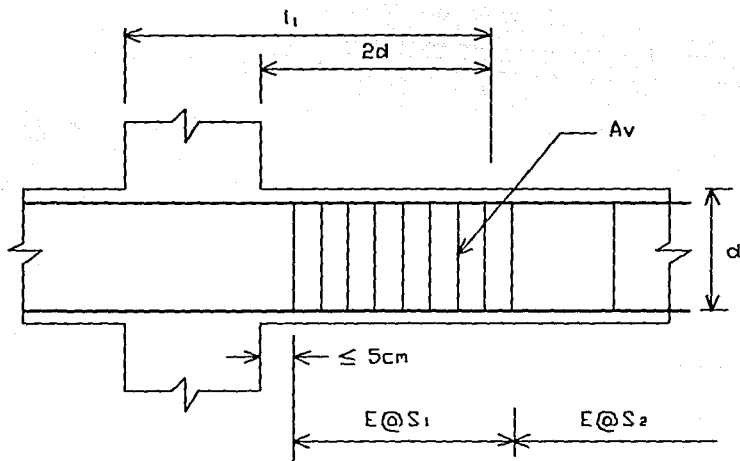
Requisitos para el refuerzo transversal de vigas de concreto. (1.6)
